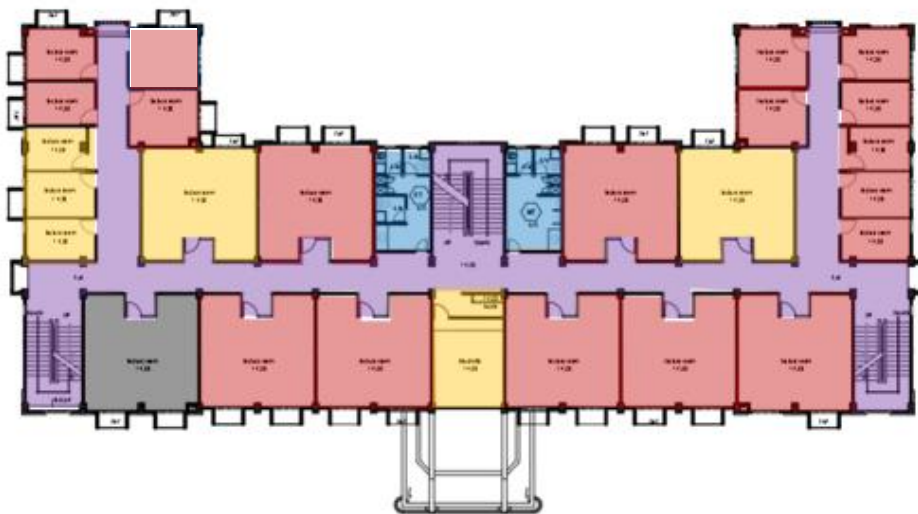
4 Pemetaan Zonasi Eksisting Lantai 1
